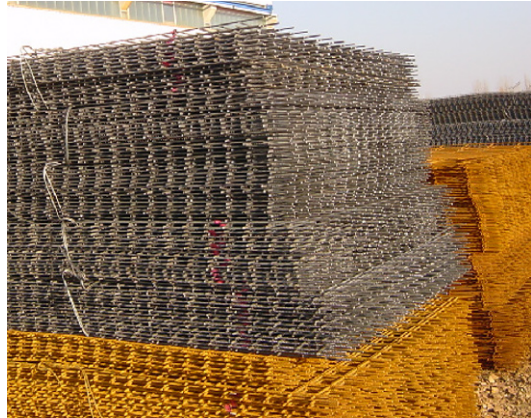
Mattenstapel in je 2 t-Bunden abgebunden
